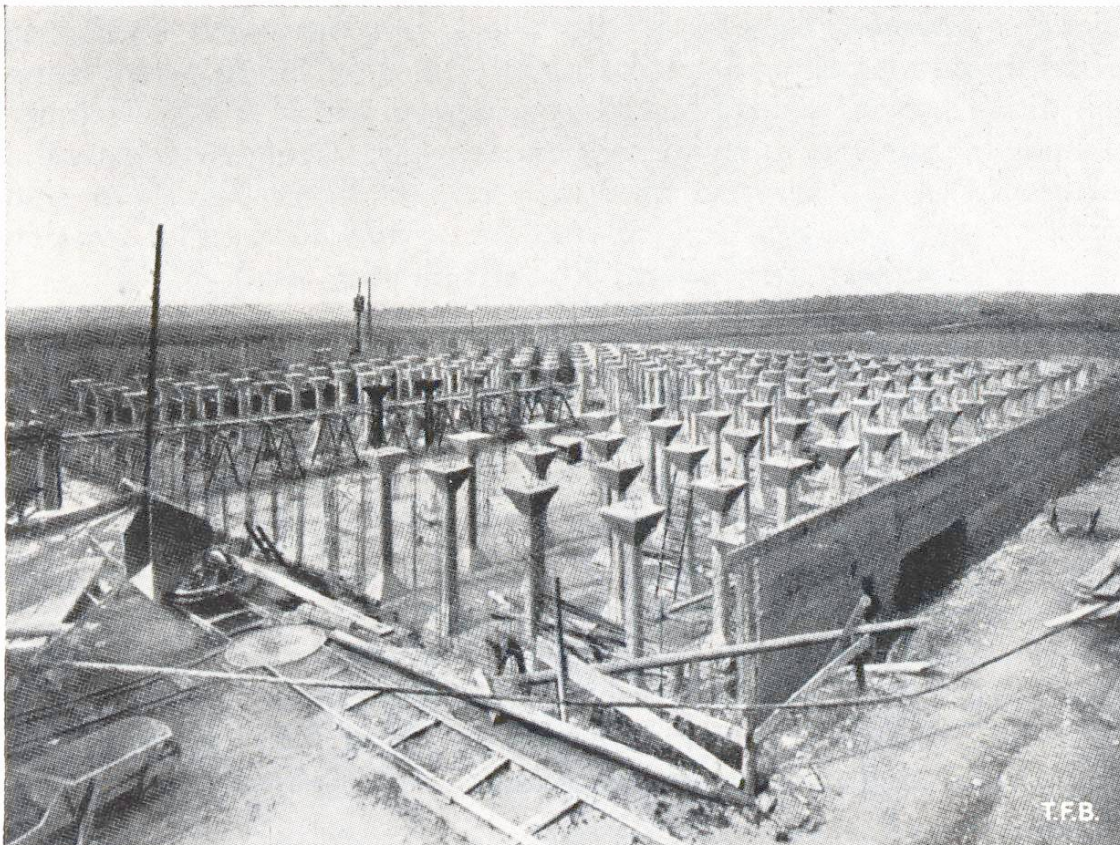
Wasserhochbehälter in Pilzdeckenkonstruktion im Bau
